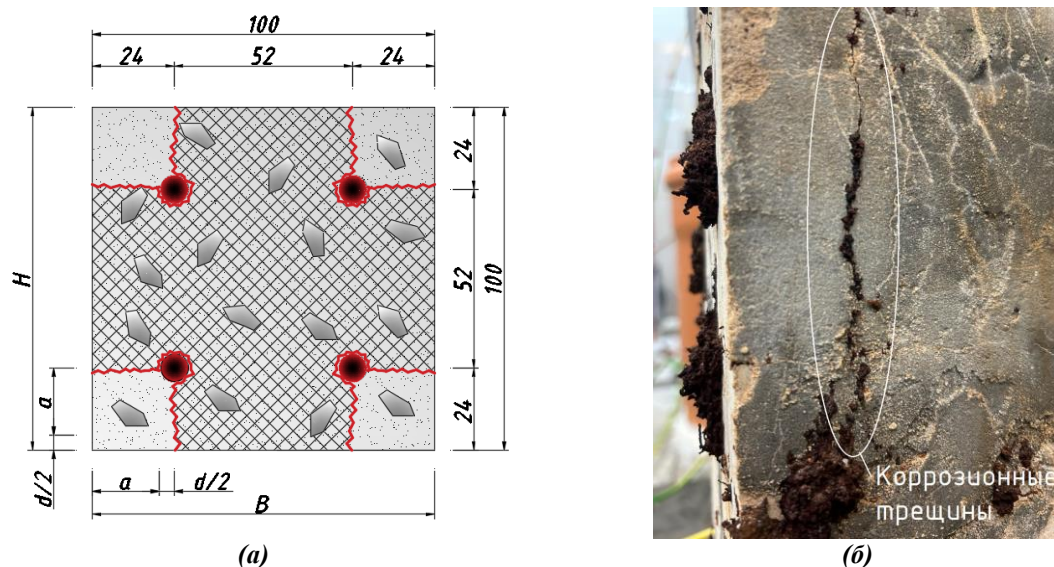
Расчетное сечение колонны с повреждением арматуры:
